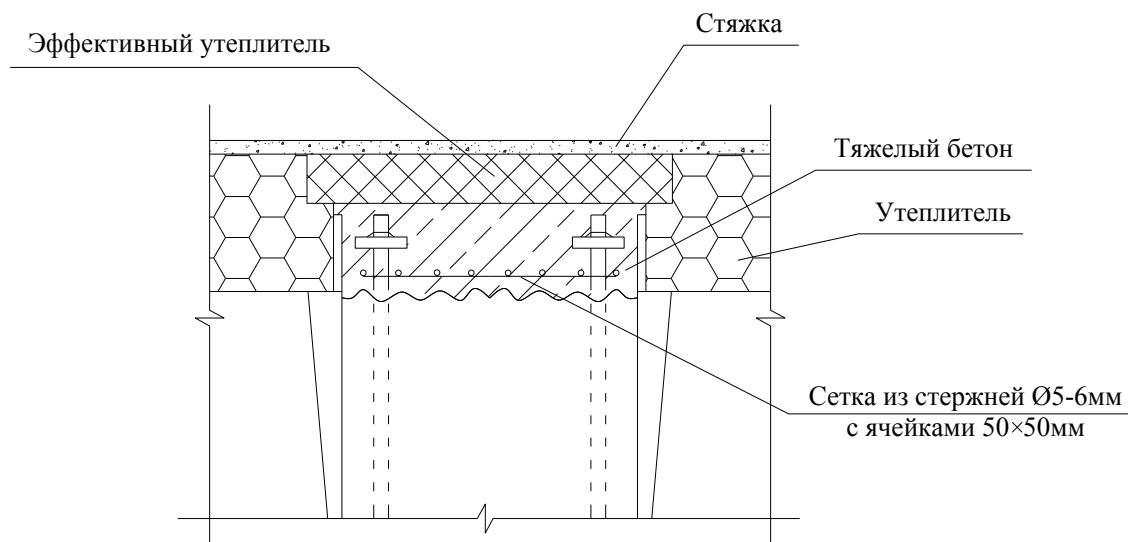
Верх колонны после демонтажа верхнего этажа
